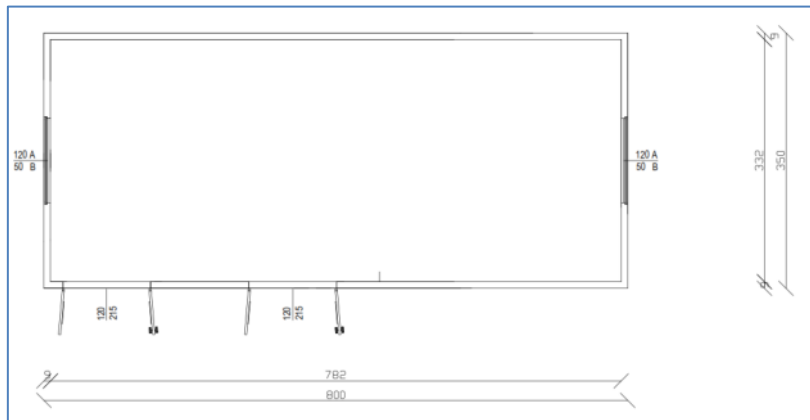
Vista in pianta/prospetto/sezione cabina di consegna.
